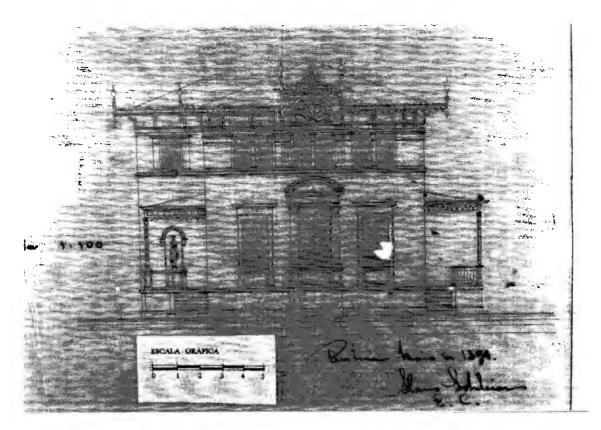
Projeto de Hans Scheleir para uma casa à Rua do Raphael, Rio Vermelho, em 1894. Fachada Principal.
